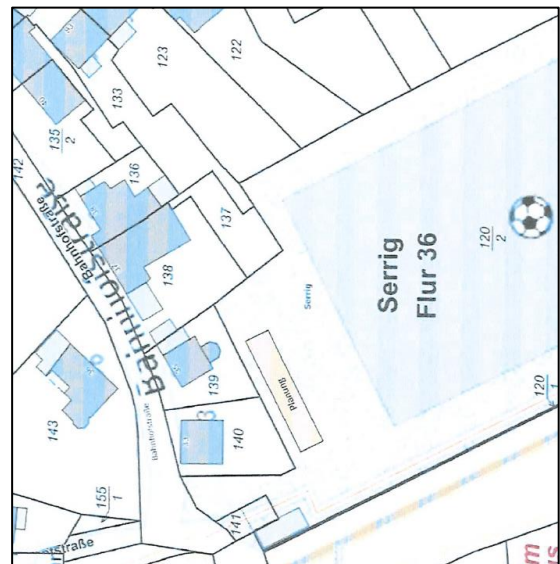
Auszug Lageplan zum Bauantrag⁵; ohne Maßstab
